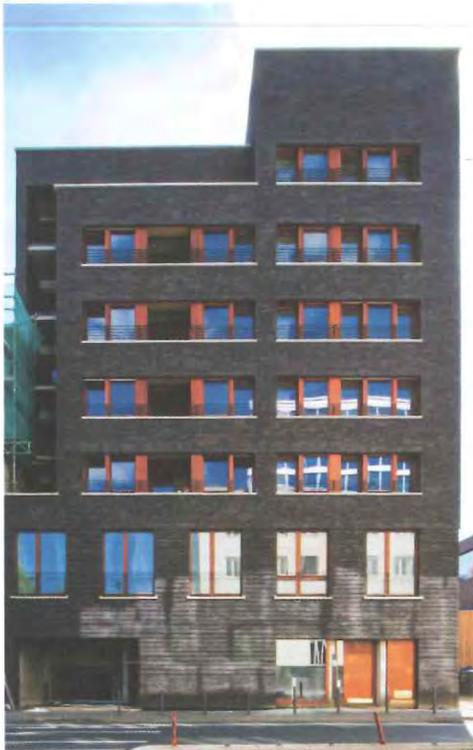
Straßenfassade des Gemeindezentrums mit Tiefgaragenzufahrt im 2-geschossigen, kirchlich genutzten Sockelbereich mit fünf Wohngeschossen darüber
